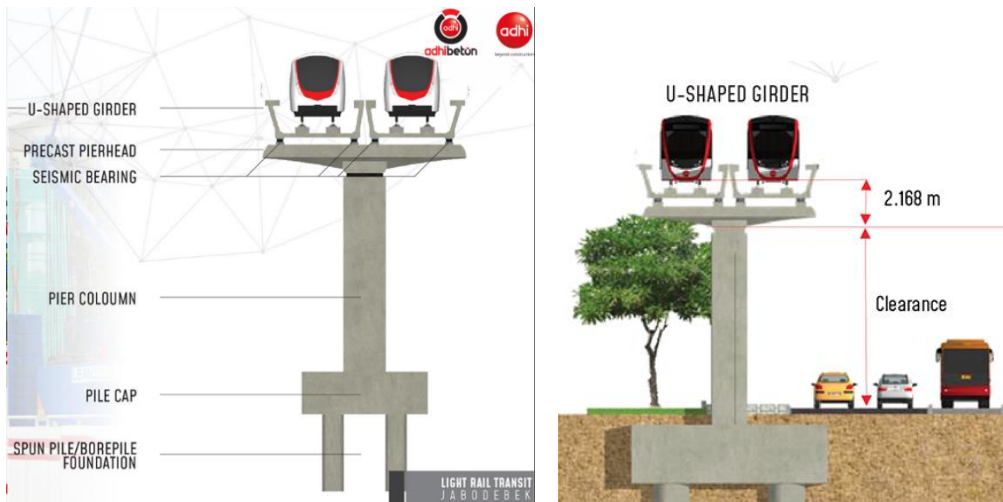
Struktur Pier Penyokong Sistem LRT Palembang
